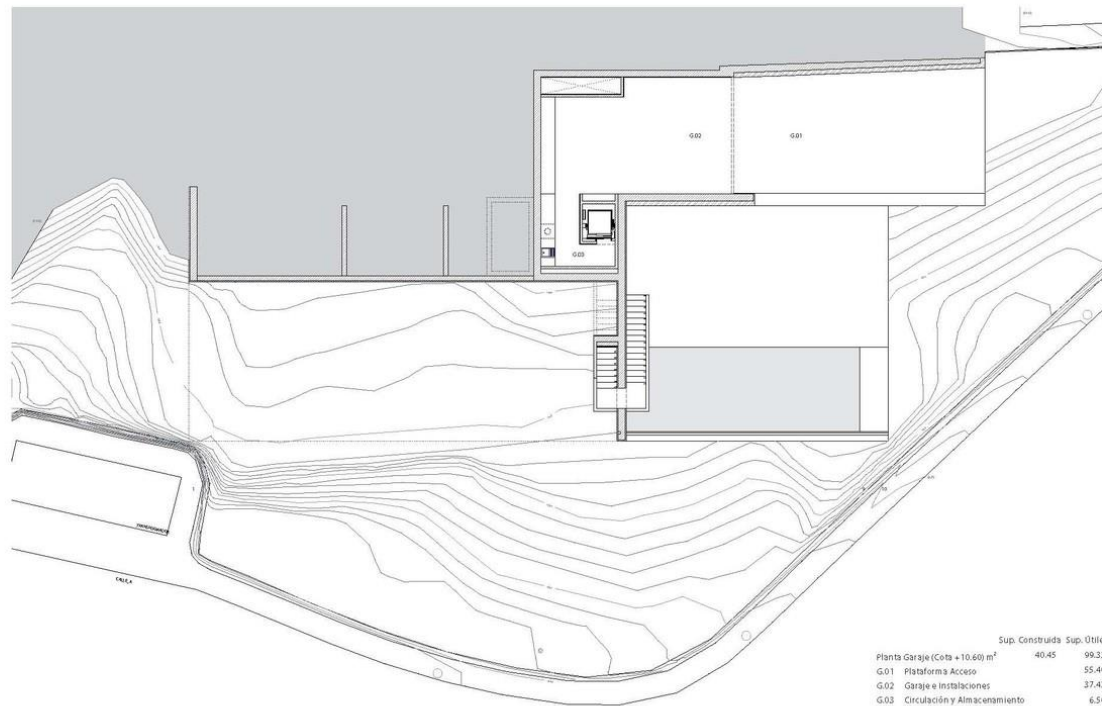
Plano planta acceso garaje (Cota +10.60m). Fuente: Fran Silvestre Arquitectos.
